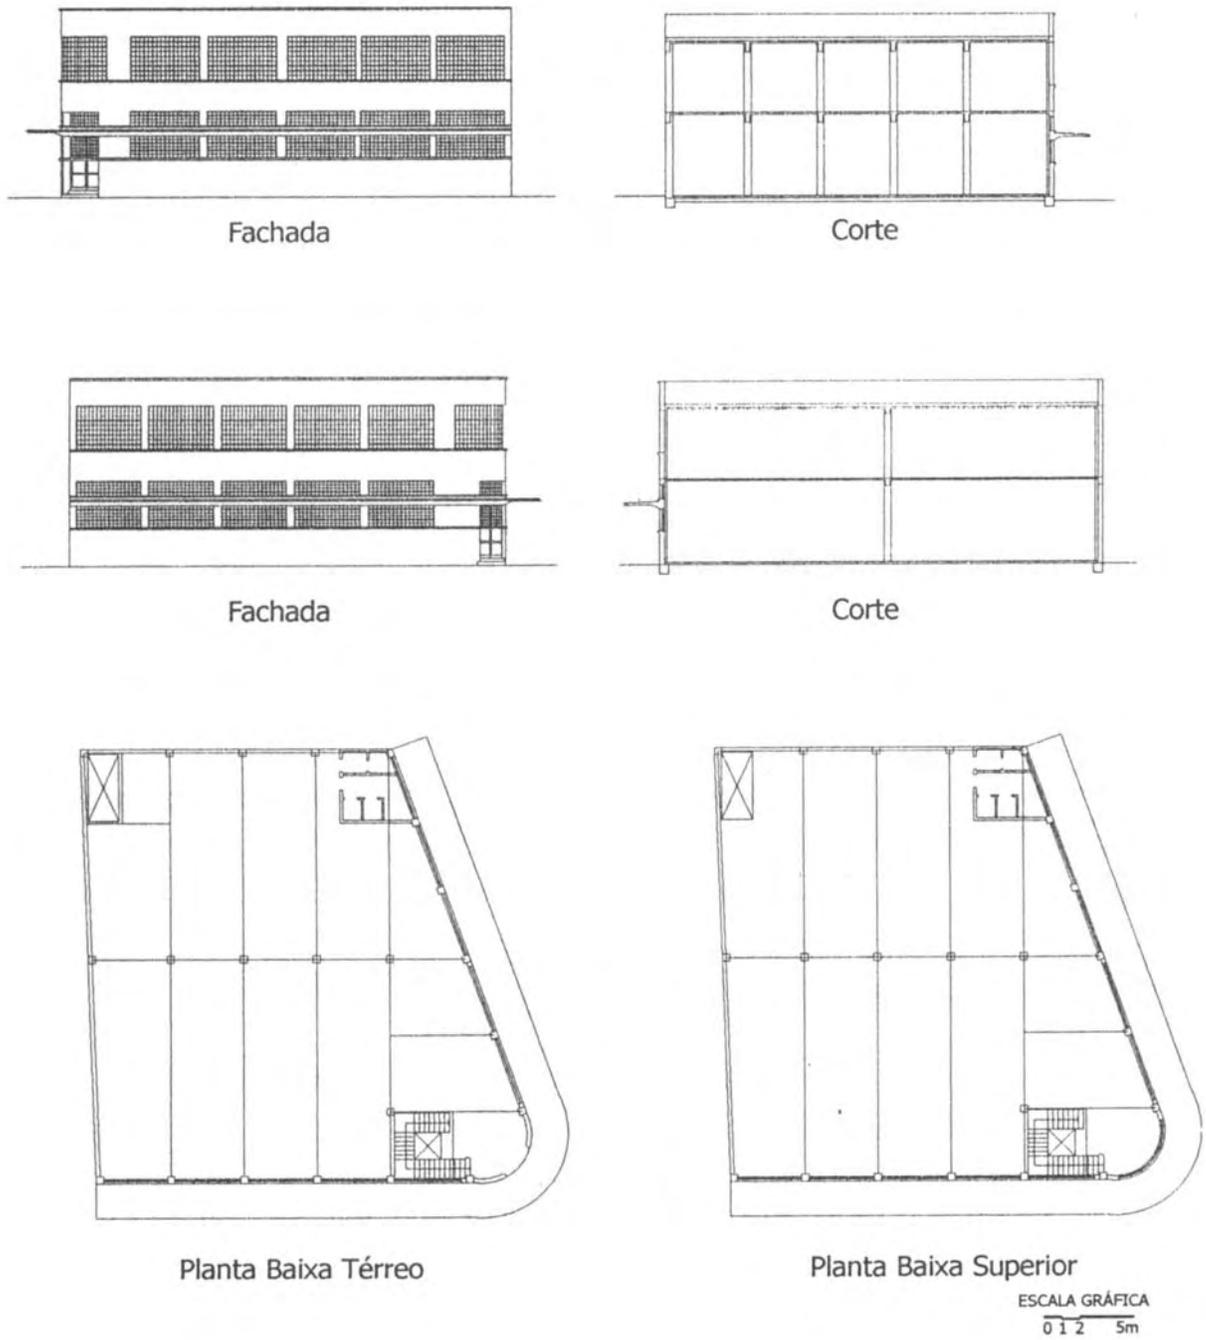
Plantas baixas , cortes e fachadas da tecelagem Renner. Egon Weindorfer, 1934.
